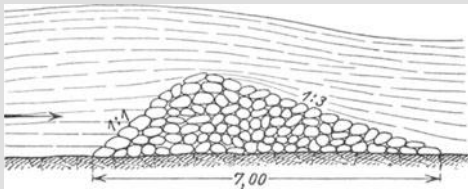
Stein- und Grundschwelle. Maßstab 1 : 152.
